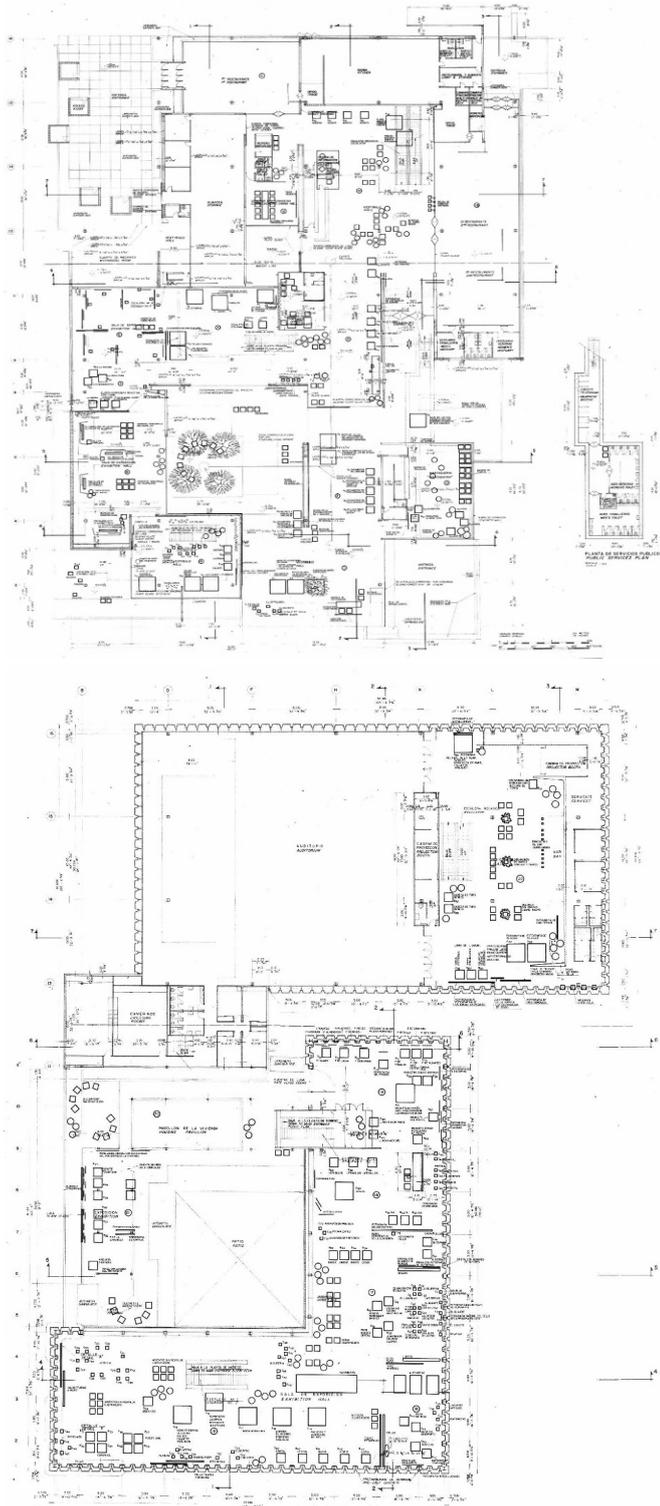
Plantas baja y primera con la posición de los elementos de exposición. (Fuente: AGUN).
